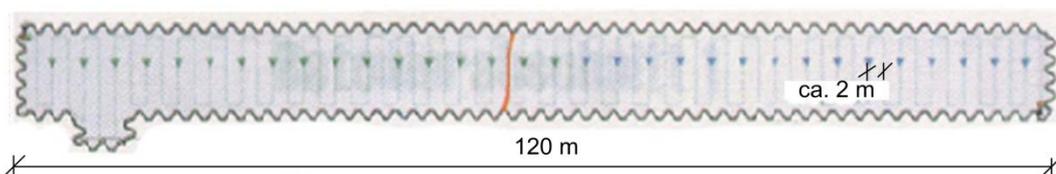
Betonierplan zur Führung des Betonierrohres [18], S. 413
